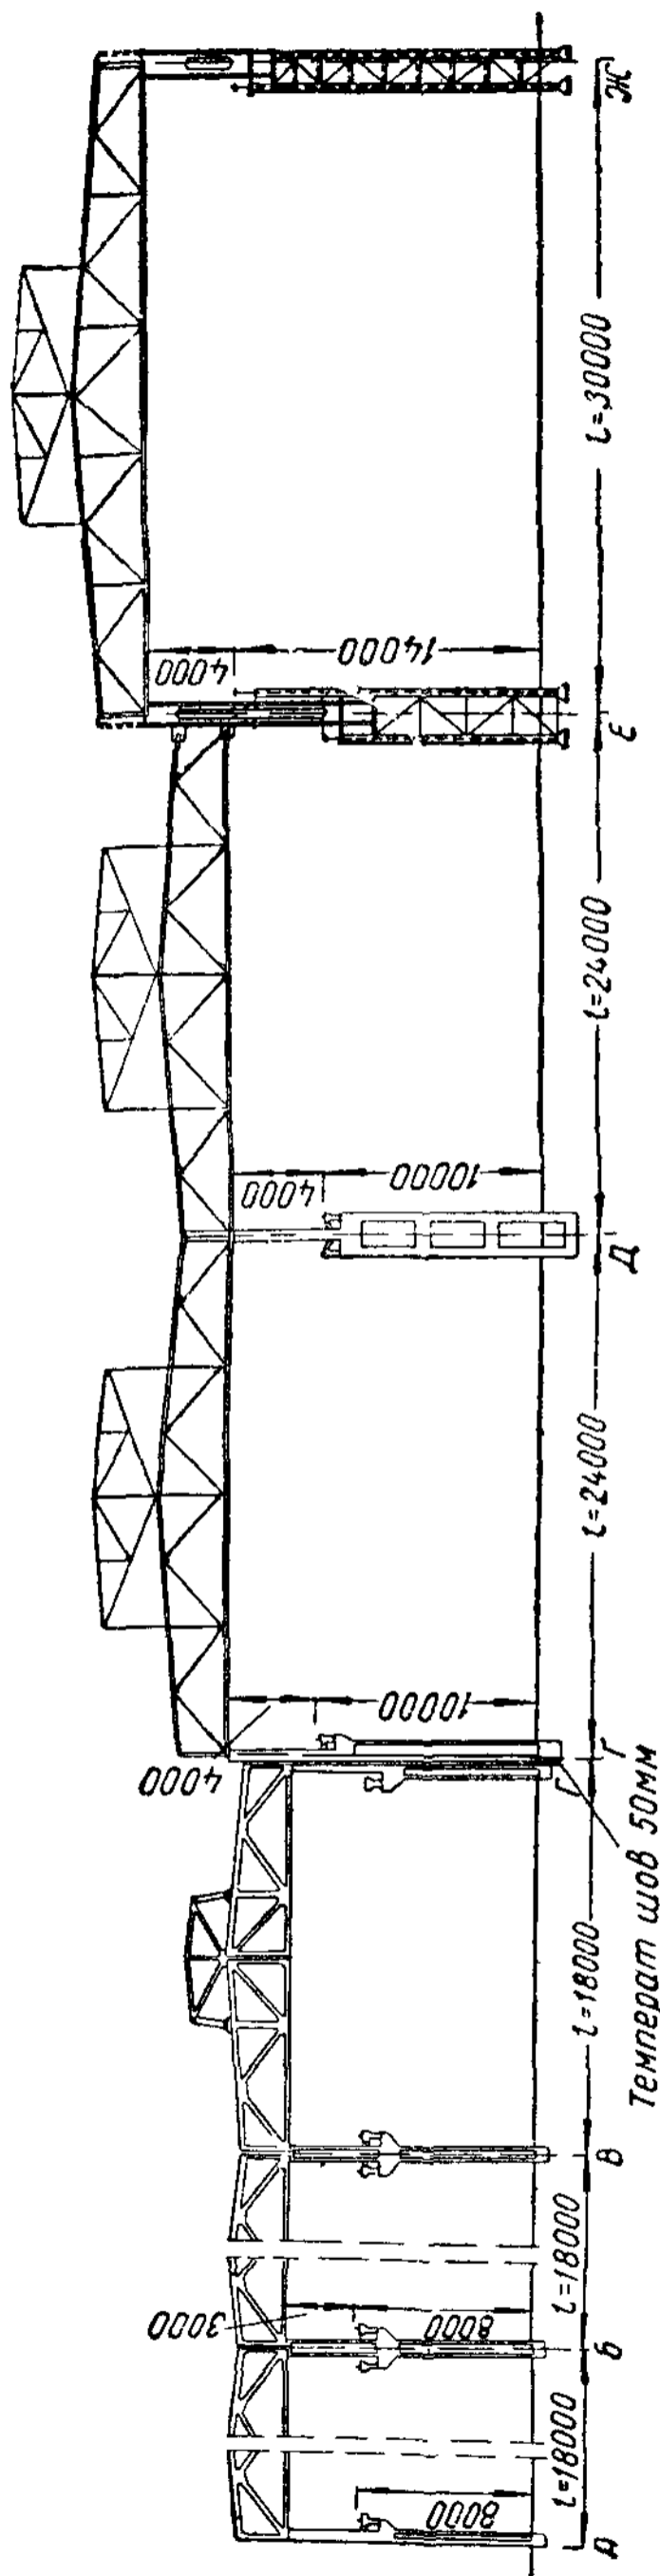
Комбинированная рама с железобетонными и стальными конструкциями (механический цех)
